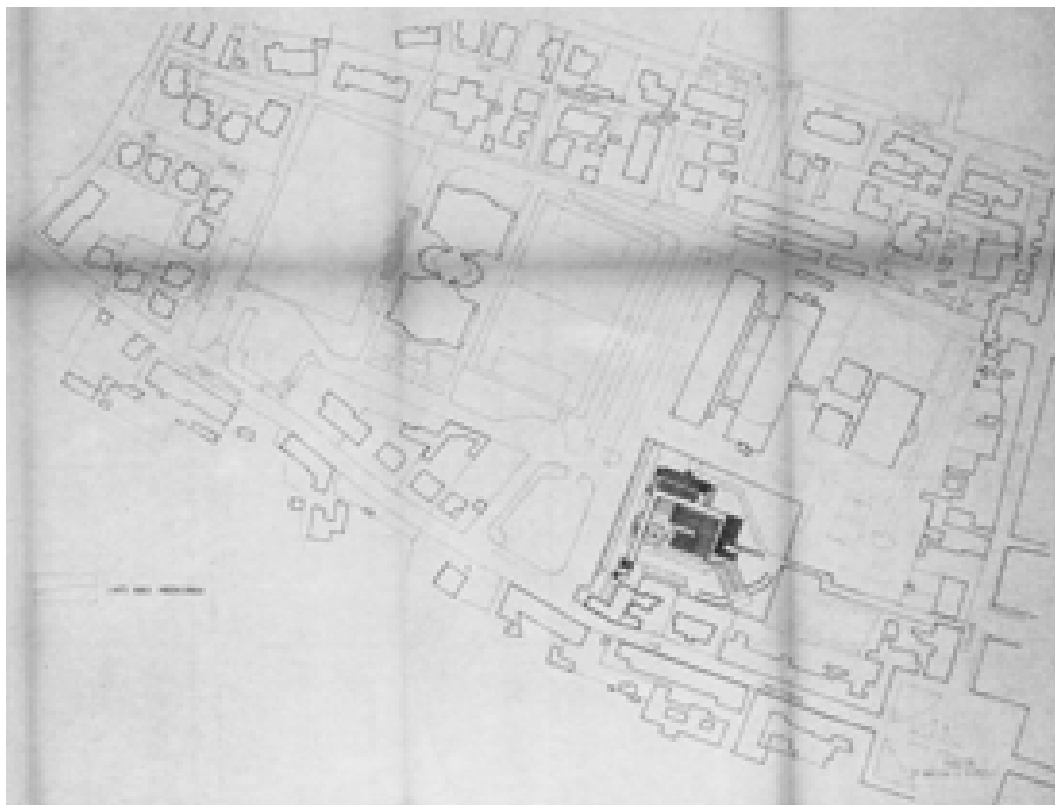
Planimetria, stato futuro – 12/09/1991 (AABS-64_574)
